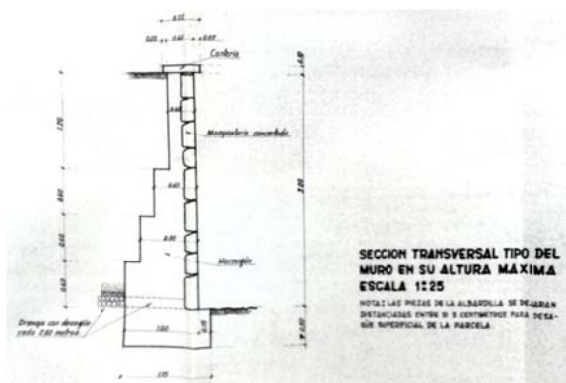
Plano muro de contención. (Echegaray, G. 1959)
